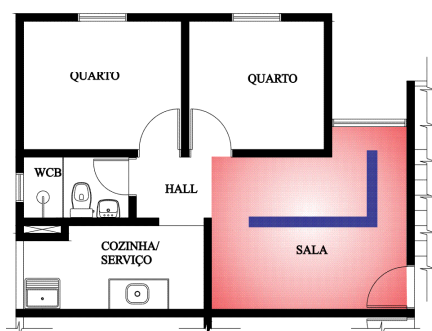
Planta Baixa Pav. Tipo do Residencial Bernardo Oiticica (sem escala)
